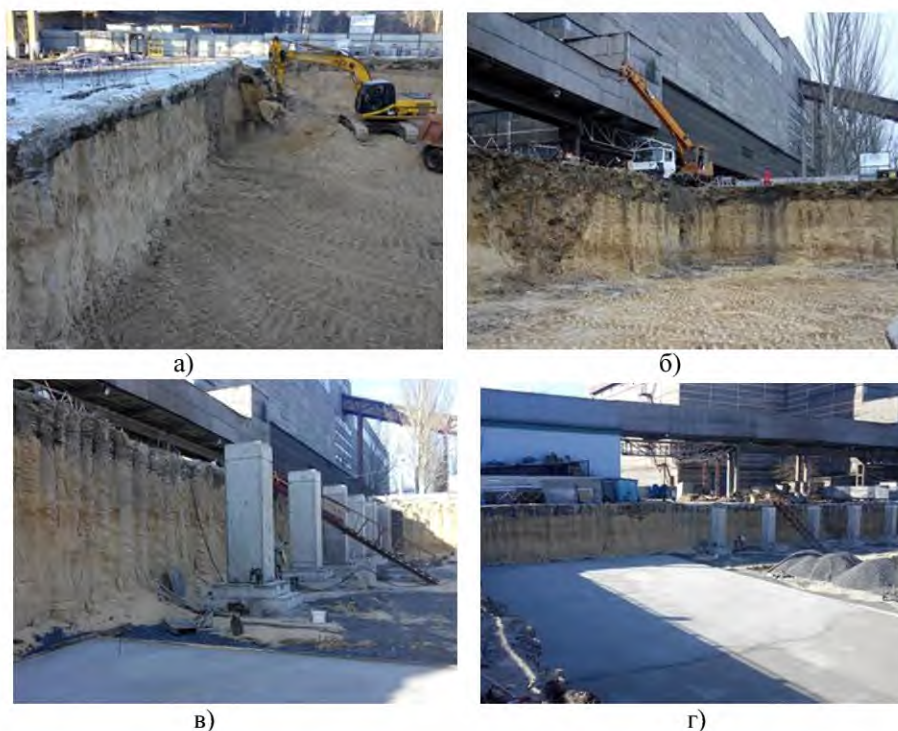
Влаштування ґрунтоцементного екрану по периметру майбутньої промислової будівлі: а – відривання котловану, вертикальні стінки якого закріплені ґрунтоцементними елементами; б – застосування ґрунтоцементу для закріплення стінок котловану при будівництві поряд з існуючою будівлею; в, г – влаштування горизонтальної гідроізоляції з ґрунтоцементу та монтаж фундаментів.
